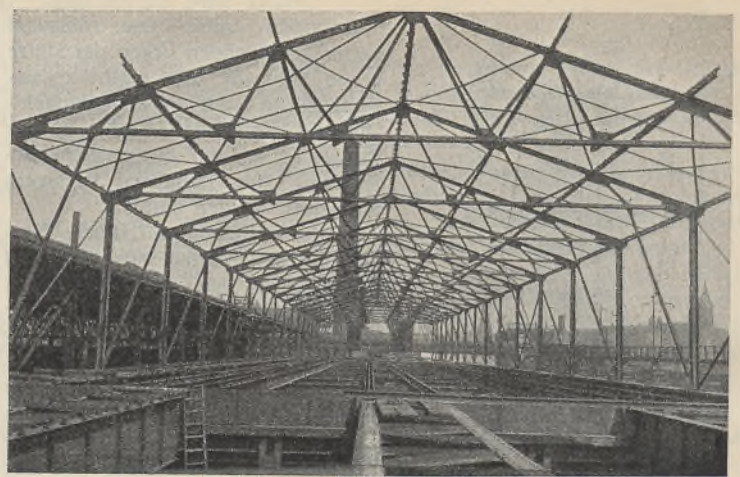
Dachkonstruktion und Aufsicht auf den fertigen Bunker.
